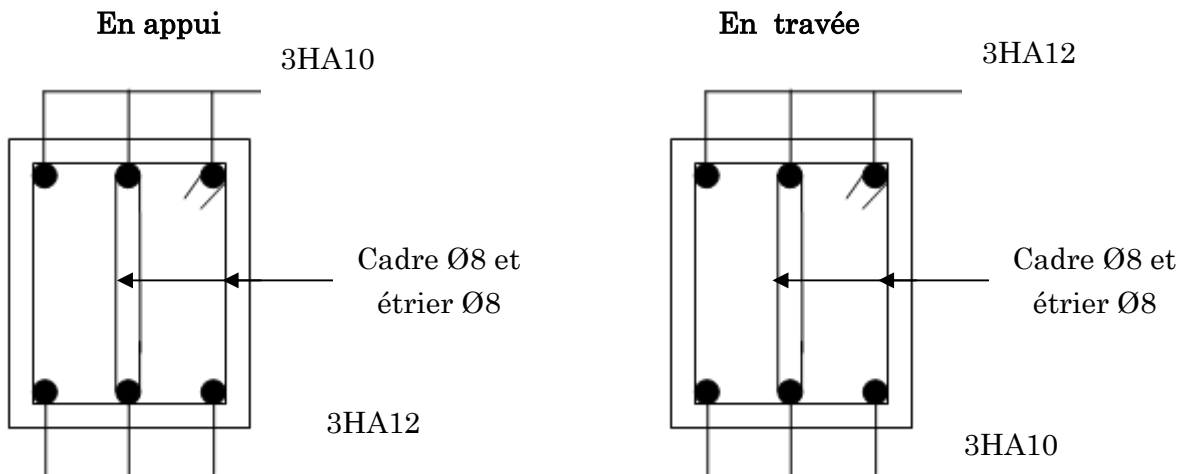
Schémas de ferrailage de la poutre de chaînage
